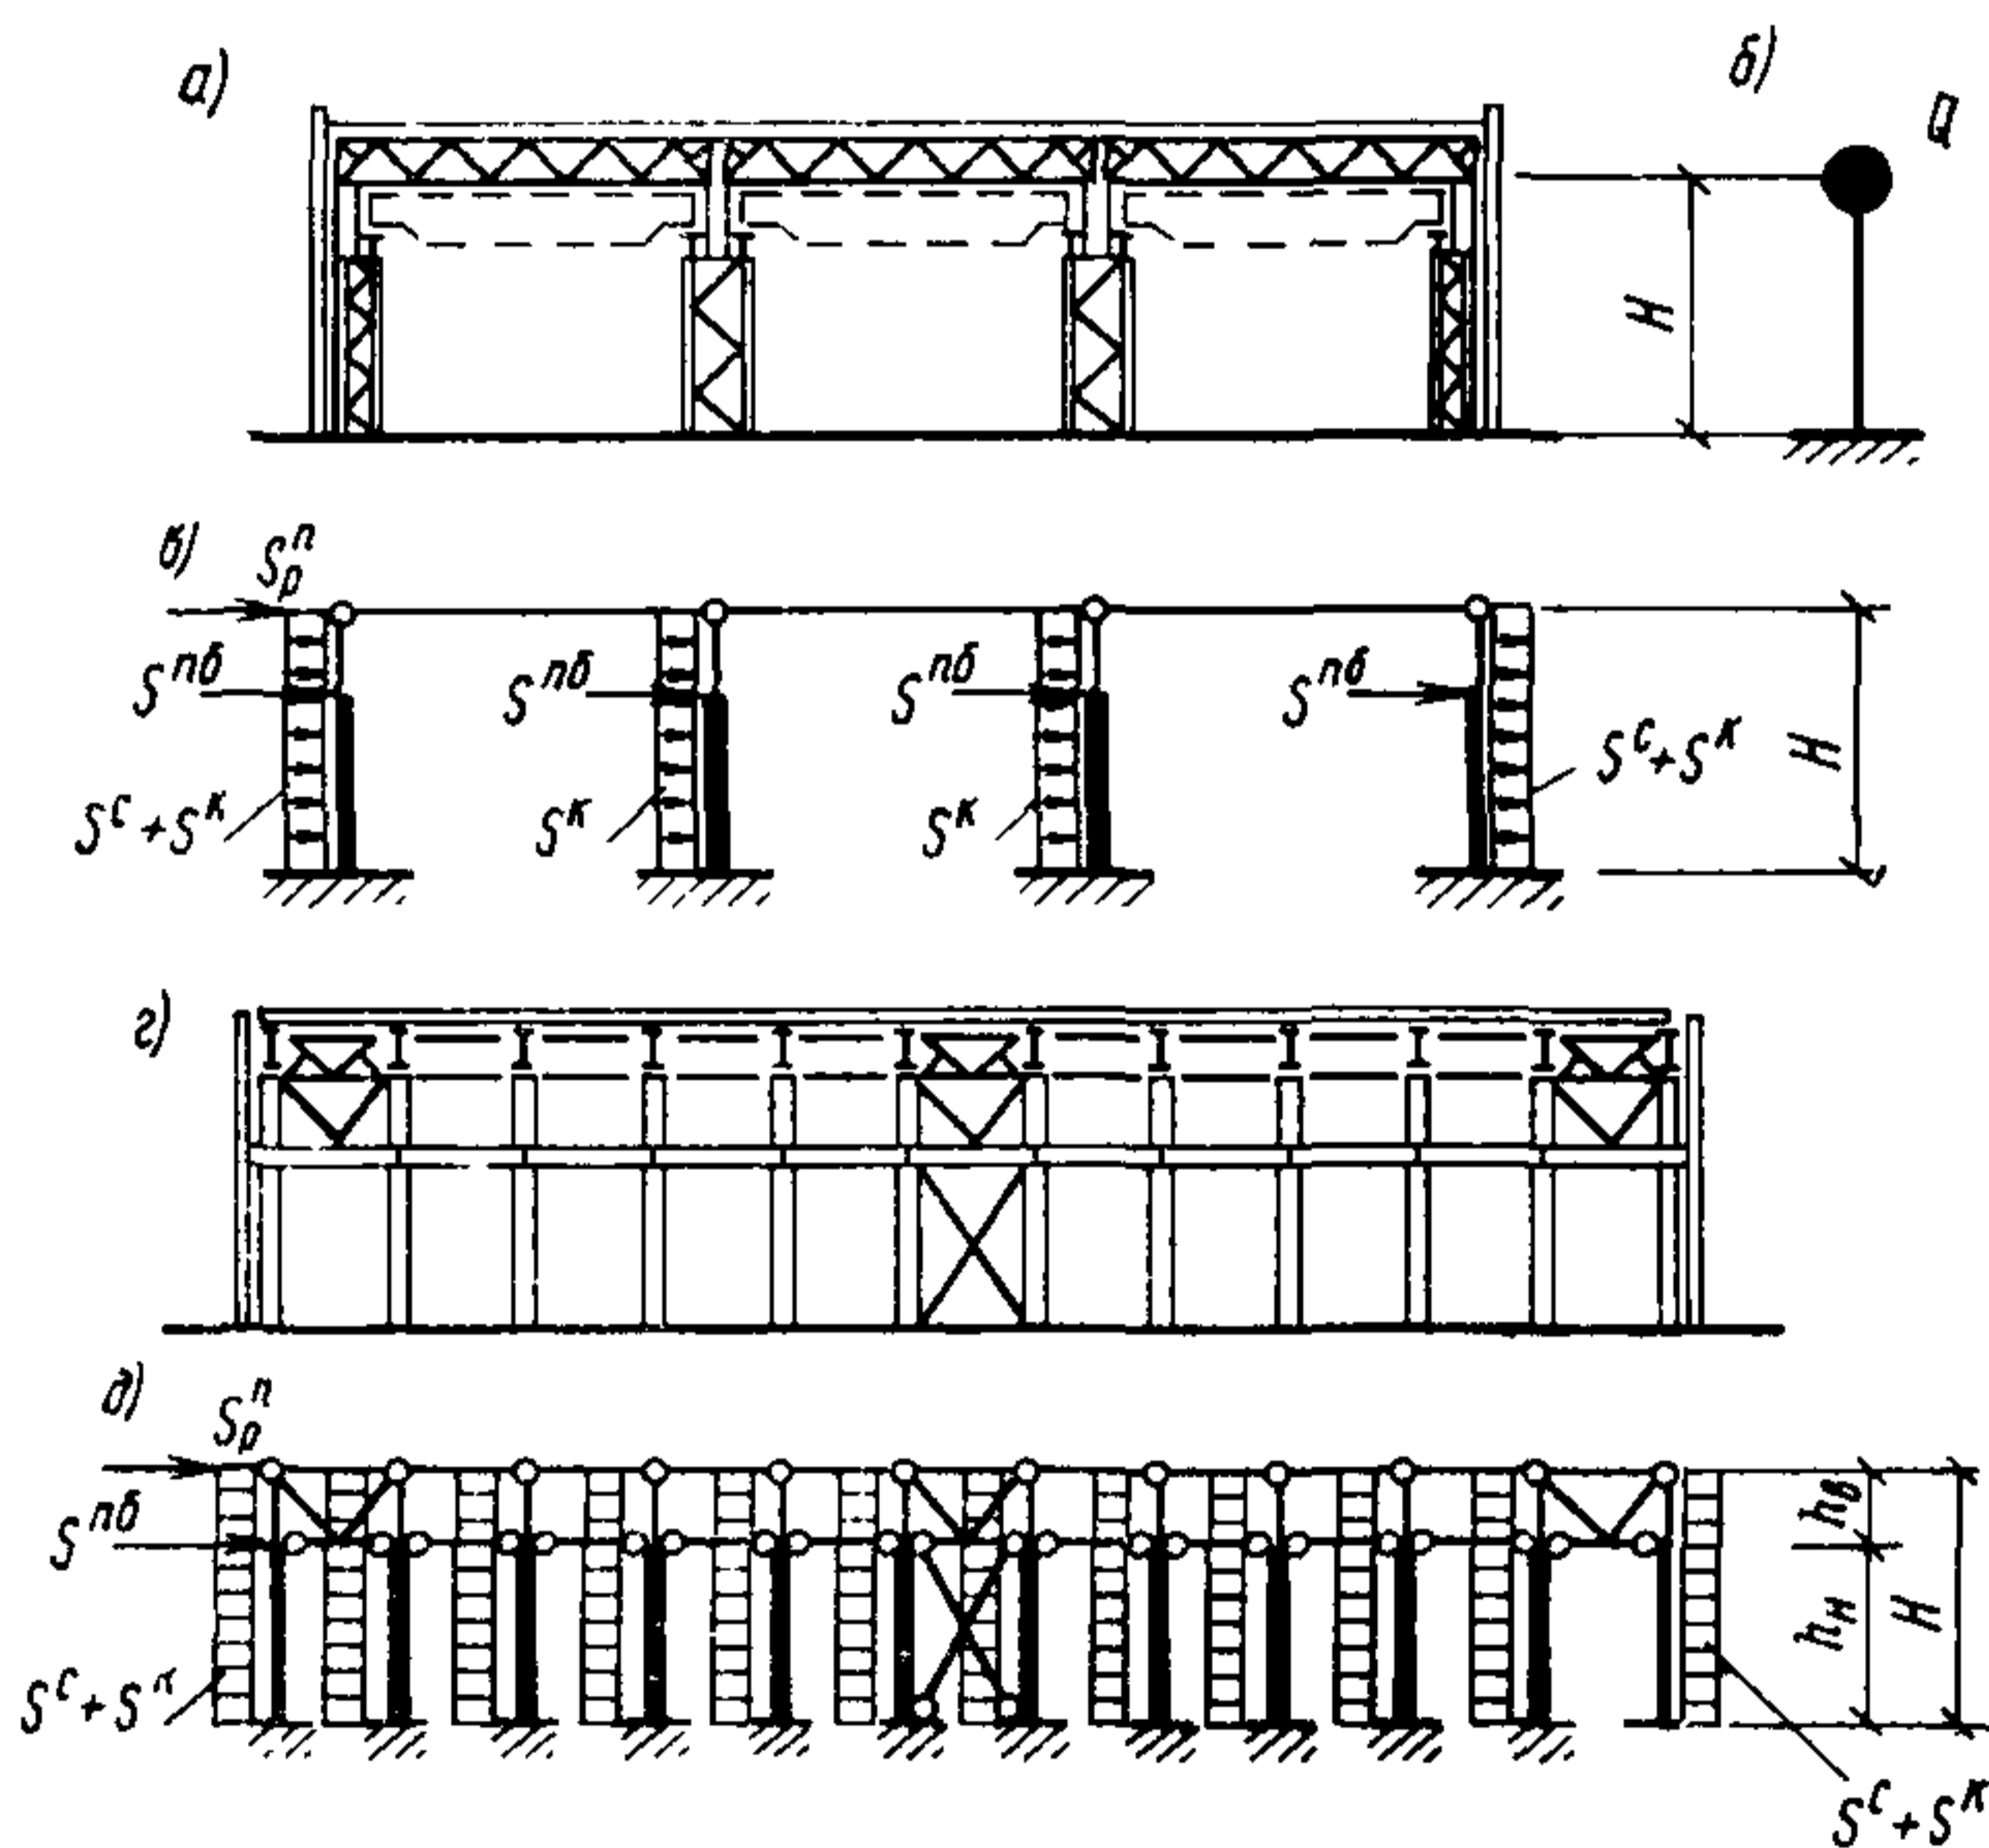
Расчетные схемы рам каркаса здания при шарнирном опирании ферм покрытия на колонны
